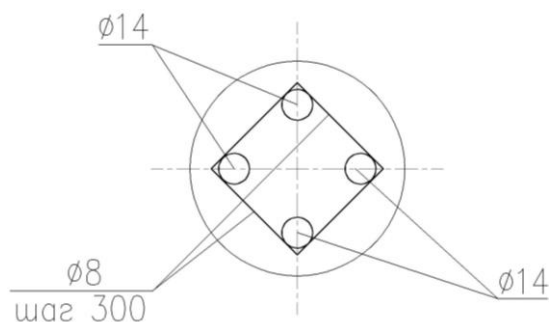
Схема армирования поперечного сечения сваи
